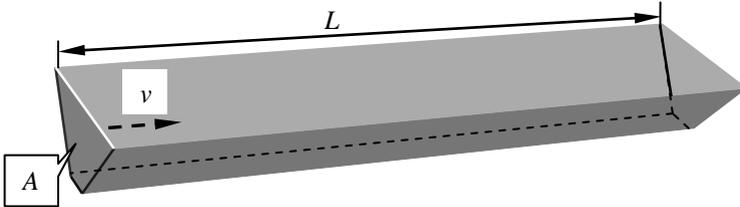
Схема к расчету объема вынутаго грунта при прокладке протяженного сооружения
